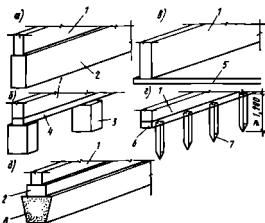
Конструктивные схемы фундаментов малоэтажных жилых зданий:
